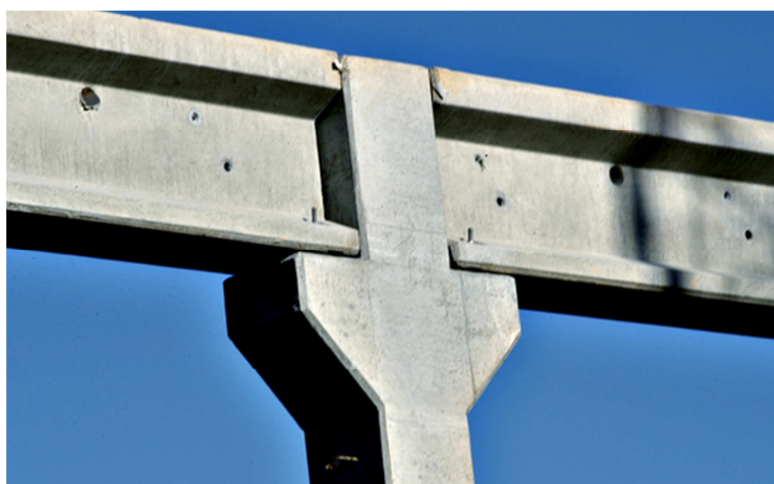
Detalhe do pilar com dois consoles trapezoidais
